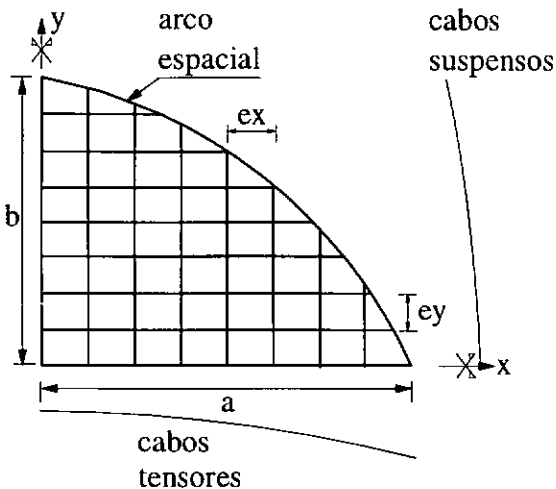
a Projeção em planta de $1/4$ da malha de cabos
